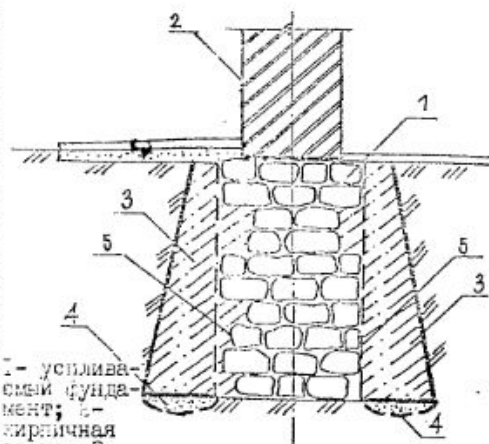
Усиление внутренних стен подвала и фундамента железобетонными обоймами
